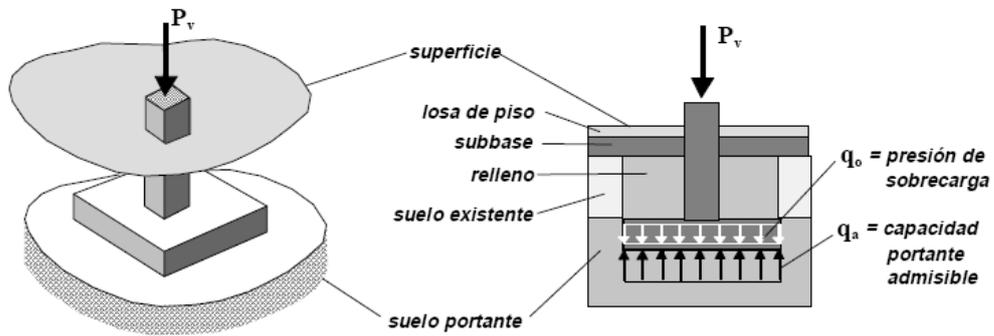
Fuerzas que actúan sobre la zapata
